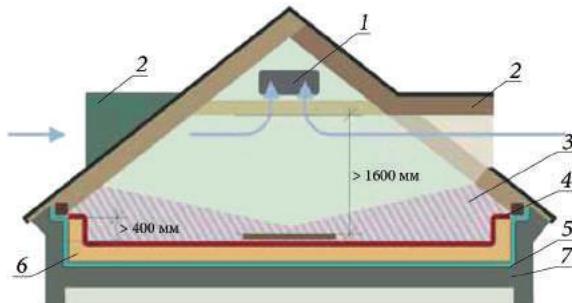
Вентиляция чердака через слуховые окна: 1 — вентиляционное отверстие (окно) в щипцовой стене; 2 — слуховое окно; 3 — зона с застойным воздухом; 4 — ветрозащита; 5 — пароизоляция; 6 — утеплитель; 7 — чердачное перекрытие
